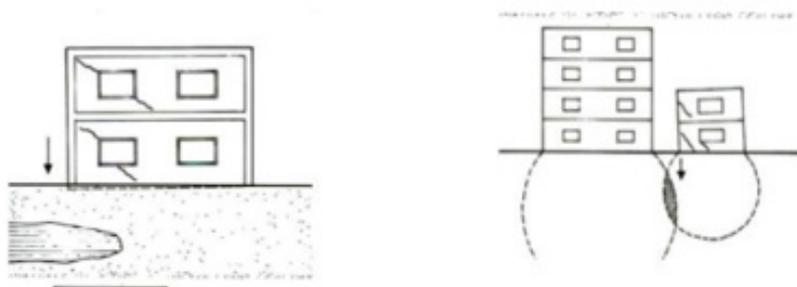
Fissuras causadas por recalque de fundação.
